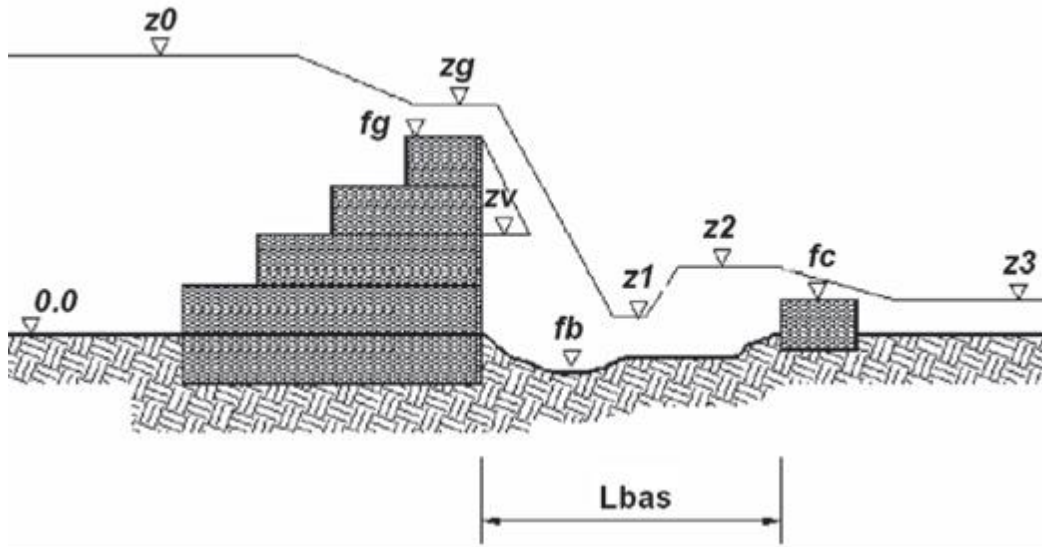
Estructura con vertedor de caída libre y contrapresa.
